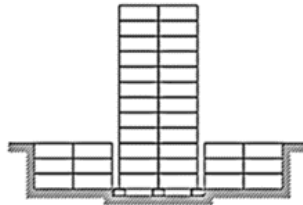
Torre del edificio aislada en el primer entrepiso
